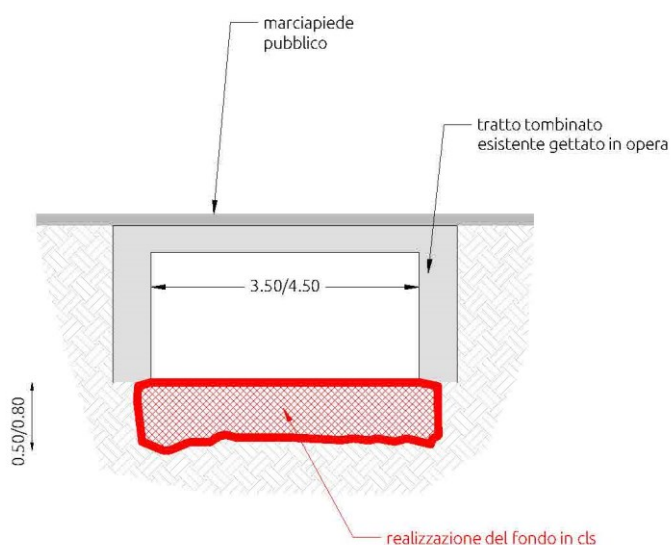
tipologia intervento ripristino del fondo in calcestruzzo armato
